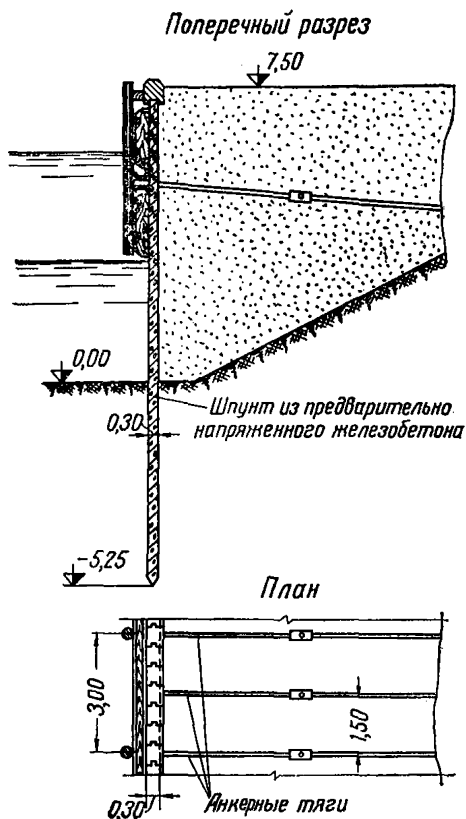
Схема конструкции причальной тонкой стенки с грунтовой засыпкой
